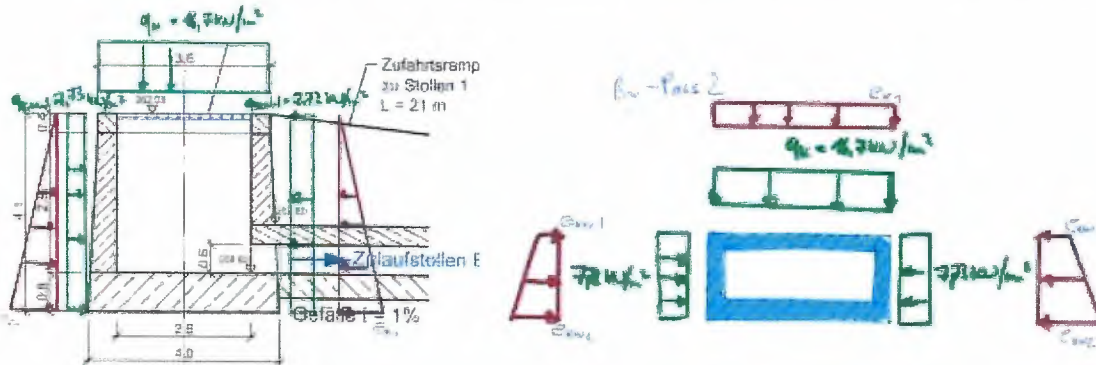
Einwirkungen auf Einlaufbauwerk Bypass 2; aus Vorstatik
